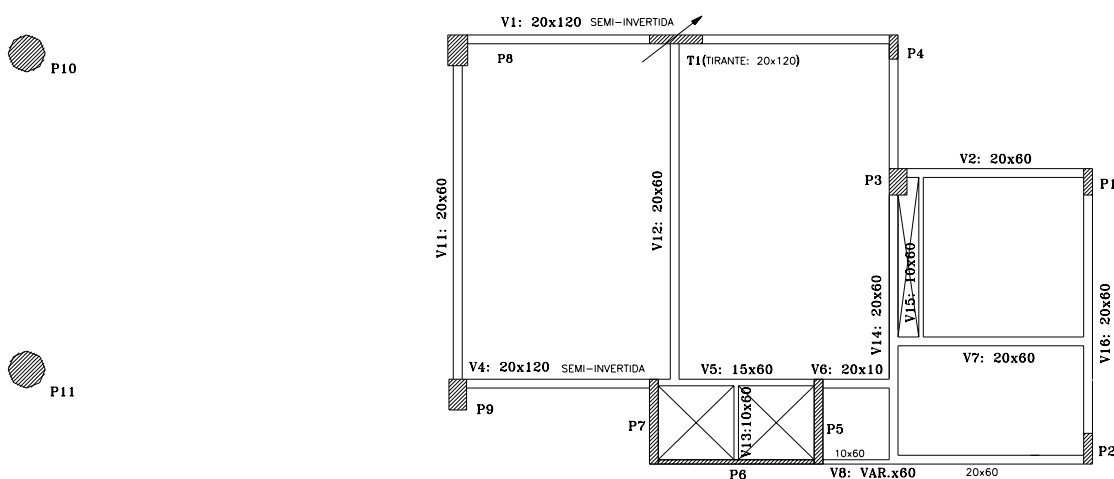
Segundo pavimento do edifício Tokio Center
